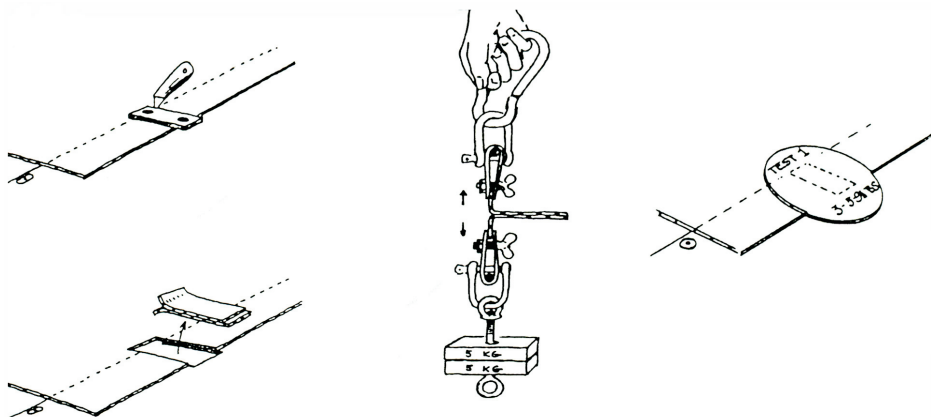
а) Проверка качества сварного шва; б) заварка вырезанного участка шва (на заплатке отмечают № испытания, дату и подпись кровельщика)
